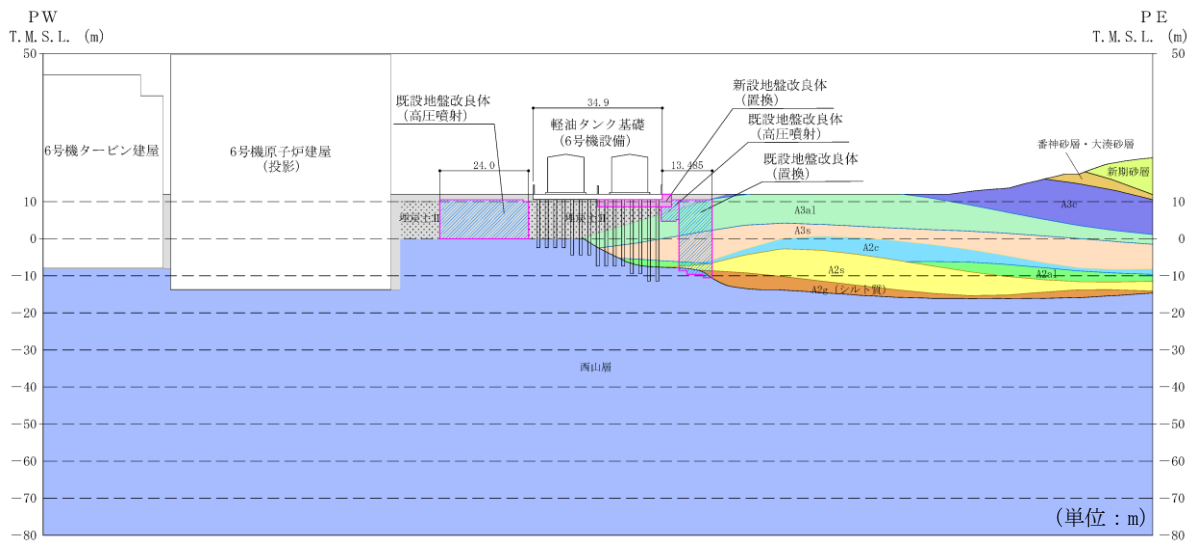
地盤改良体の配置図 (軽油タンク基礎)
